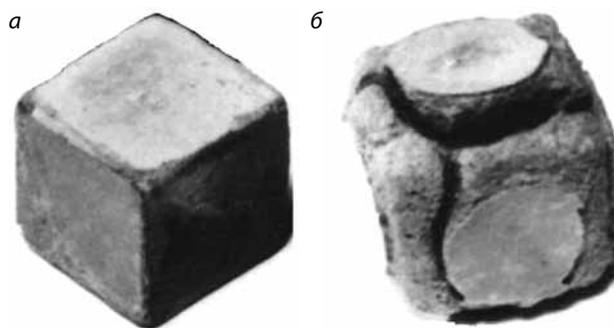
Образцы бетона после испытаний на коррозионную стойкость: а – золобетон; б – традиционный бетон
